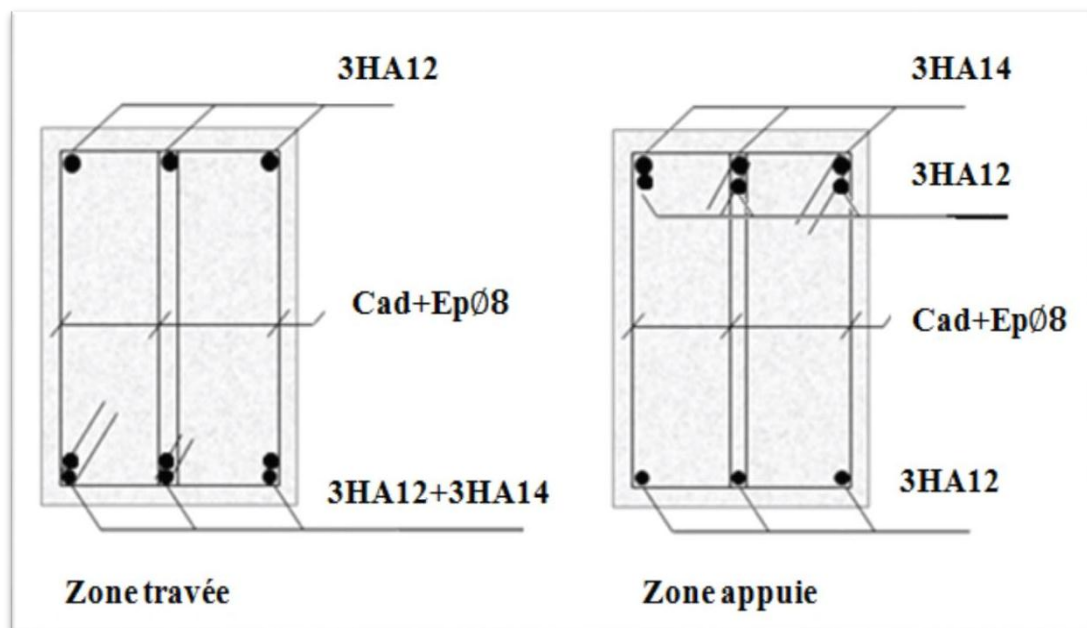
Schéma de ferrailage de la poutre secondaire.
